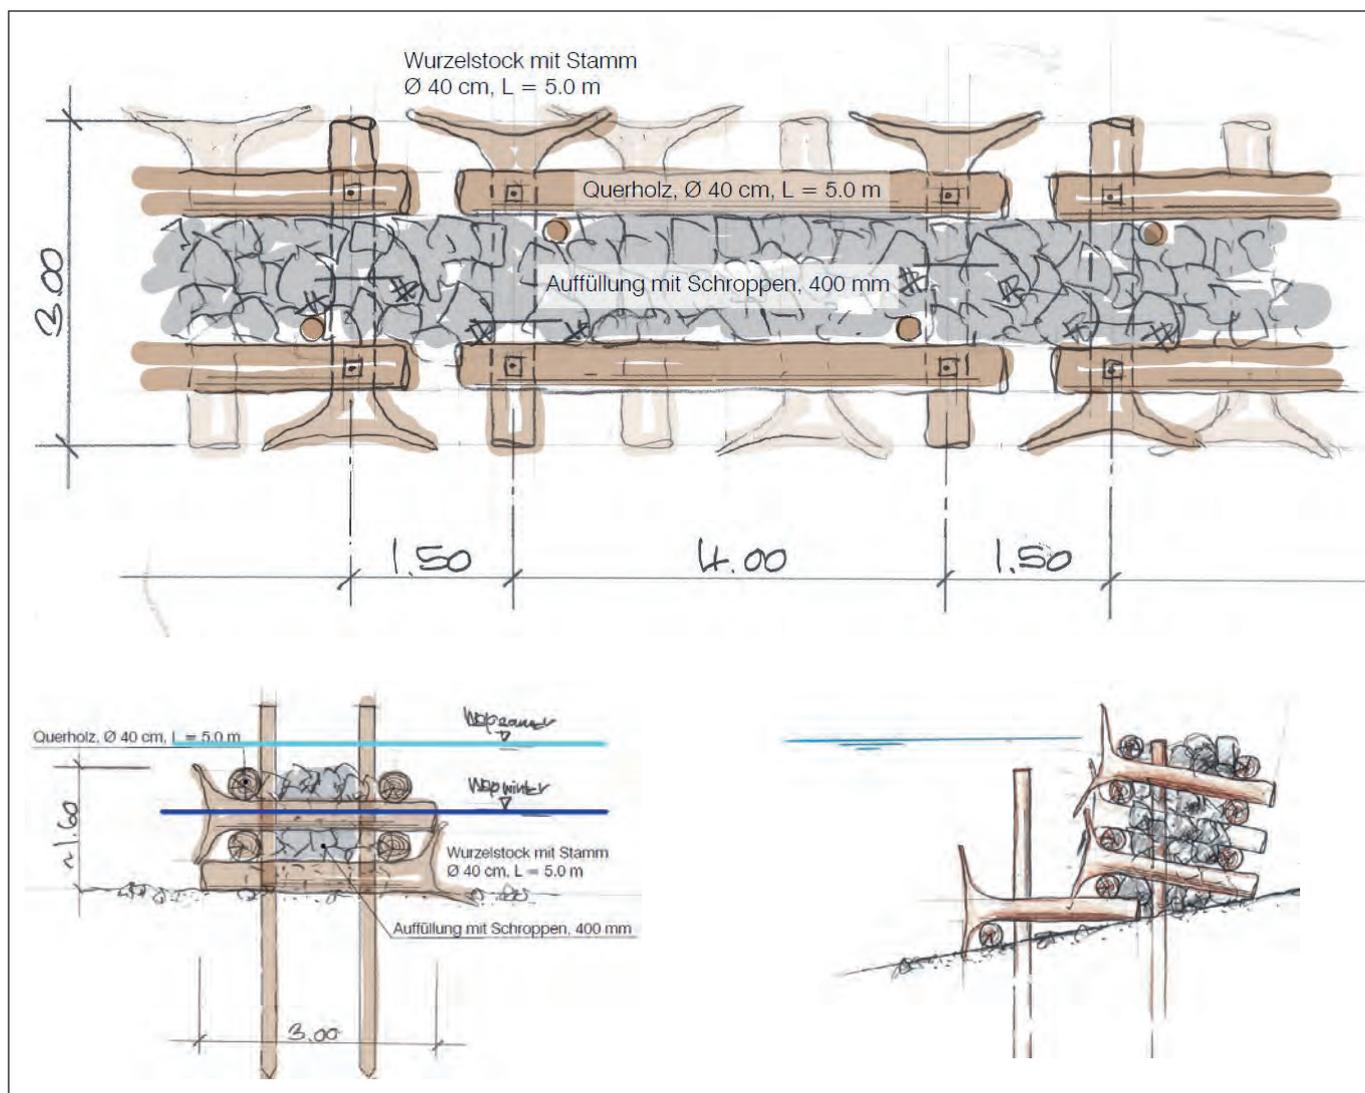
Grundriss und Querschnitte «Holzriff im Brunnen» [Stefan Tschiemer, M+W]
